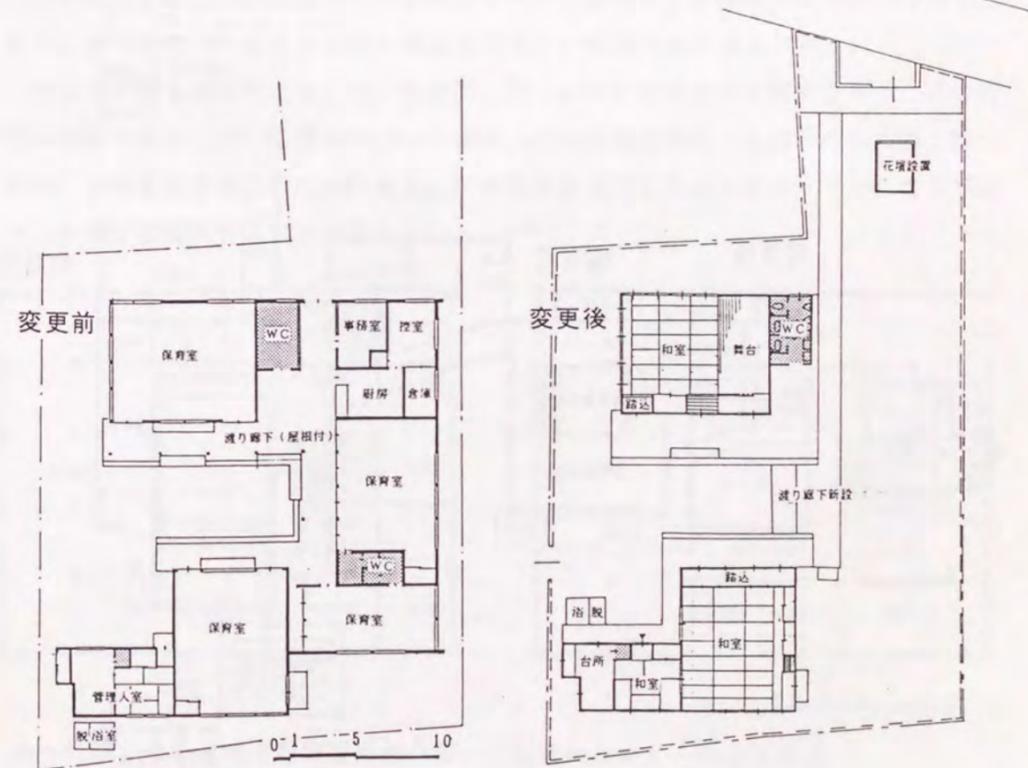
<43>奈良市横井老人憩いの家(旧保育所)平面図
